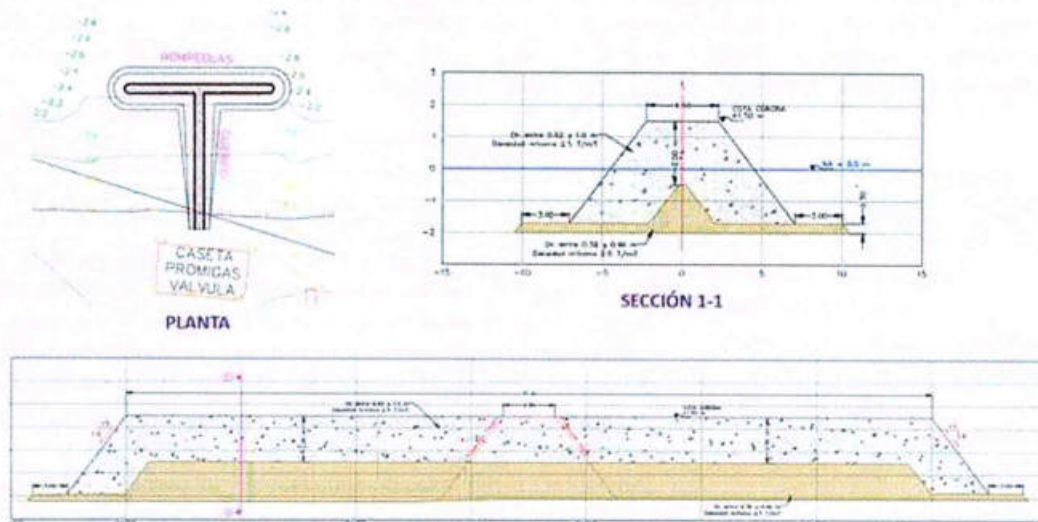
Configuración en Planta y Perfil. Espolón T – Rompeolas
